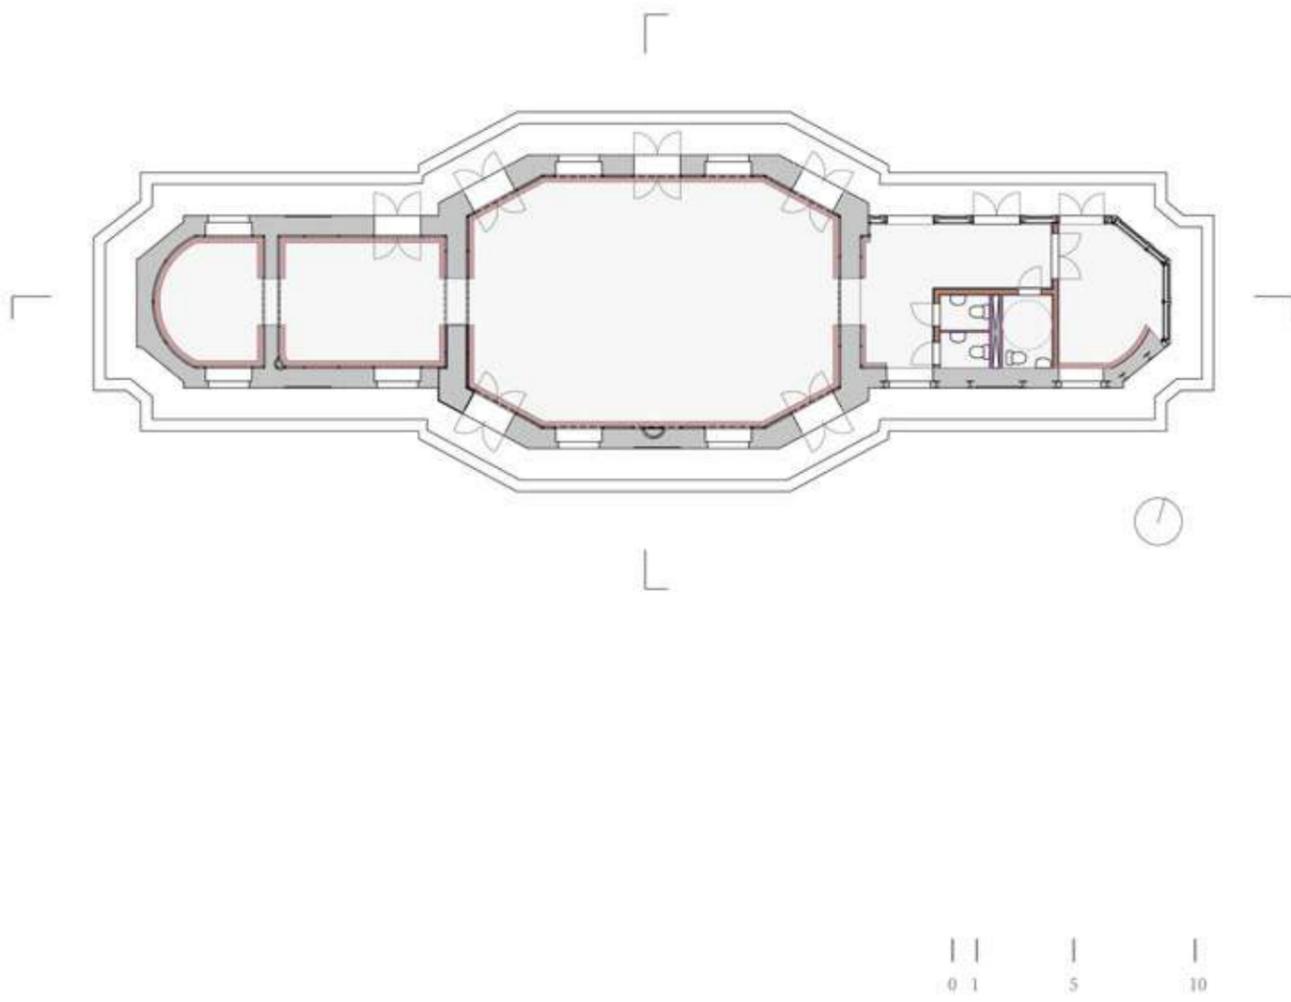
Grundriss Erdgeschoss Jagdschloss, M 1:200
